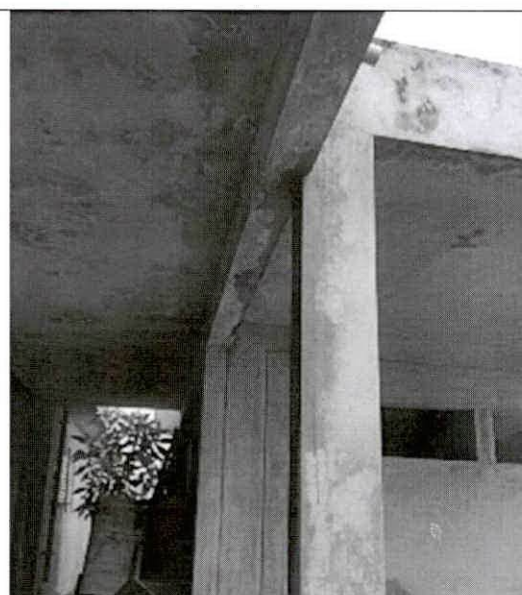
Vista inspección interior del sector E1. Se observa presencia de humedad, moho, eflorescencia en viga y losa de techo.
